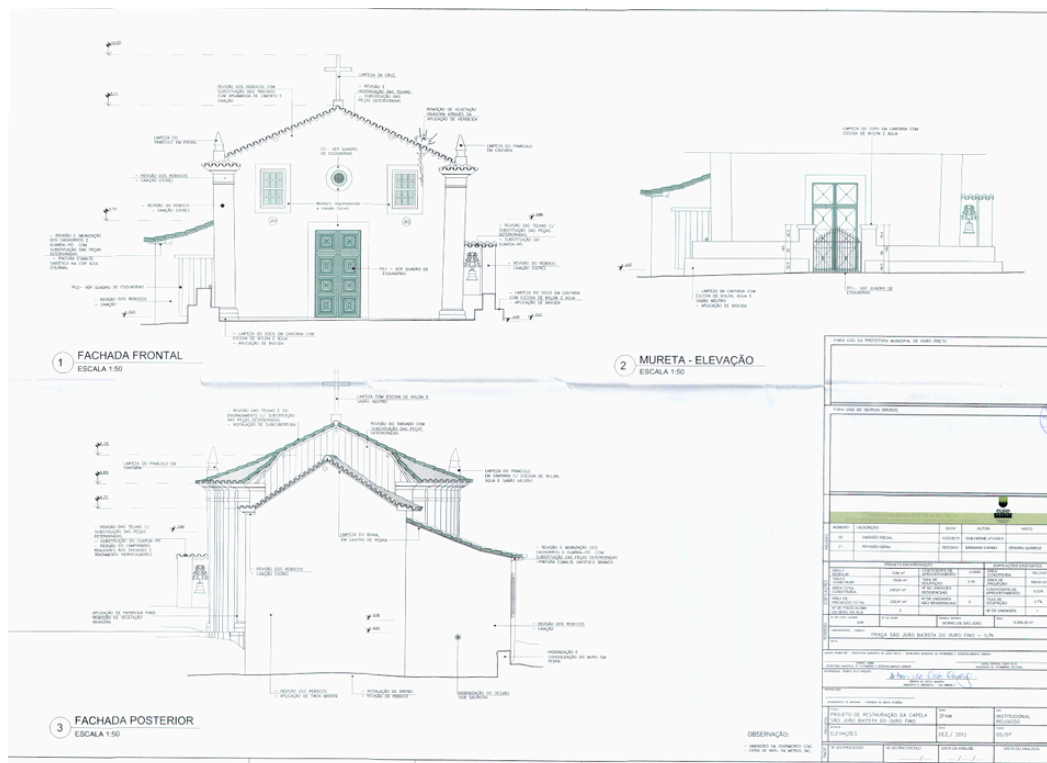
Prancha com desenho técnico da planta da Capela de São João (2009/2010).
